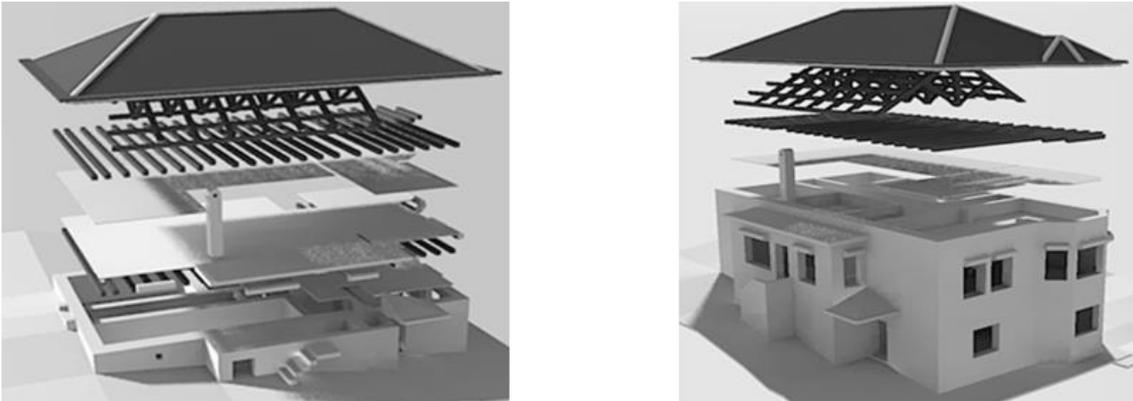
Sistema geral da estrutura da moradia (estrutura da cobertura, sistema de pavimentos, paredes estruturais primárias e secundárias): à esquerda, perspectiva do alçado norte e poente; à direita, perspectiva do alçado sul e poente (Fonte: de autor).
